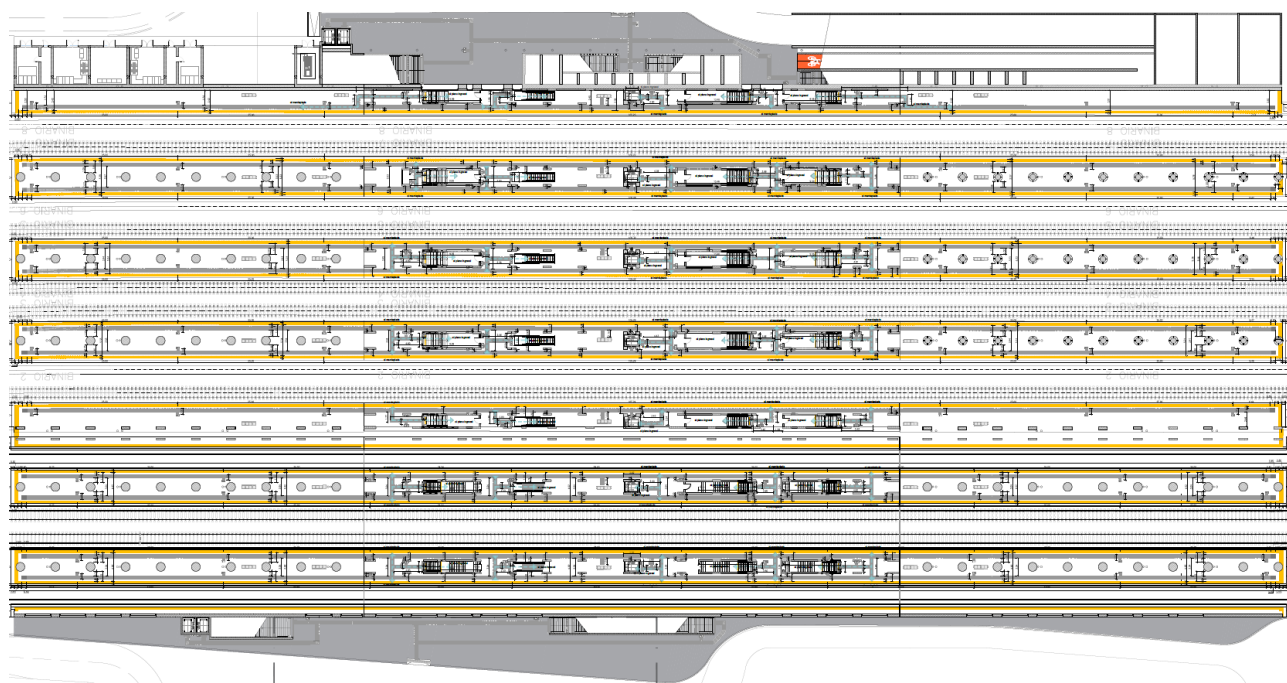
Planimetria percorsi tattili Piano Banchine.
